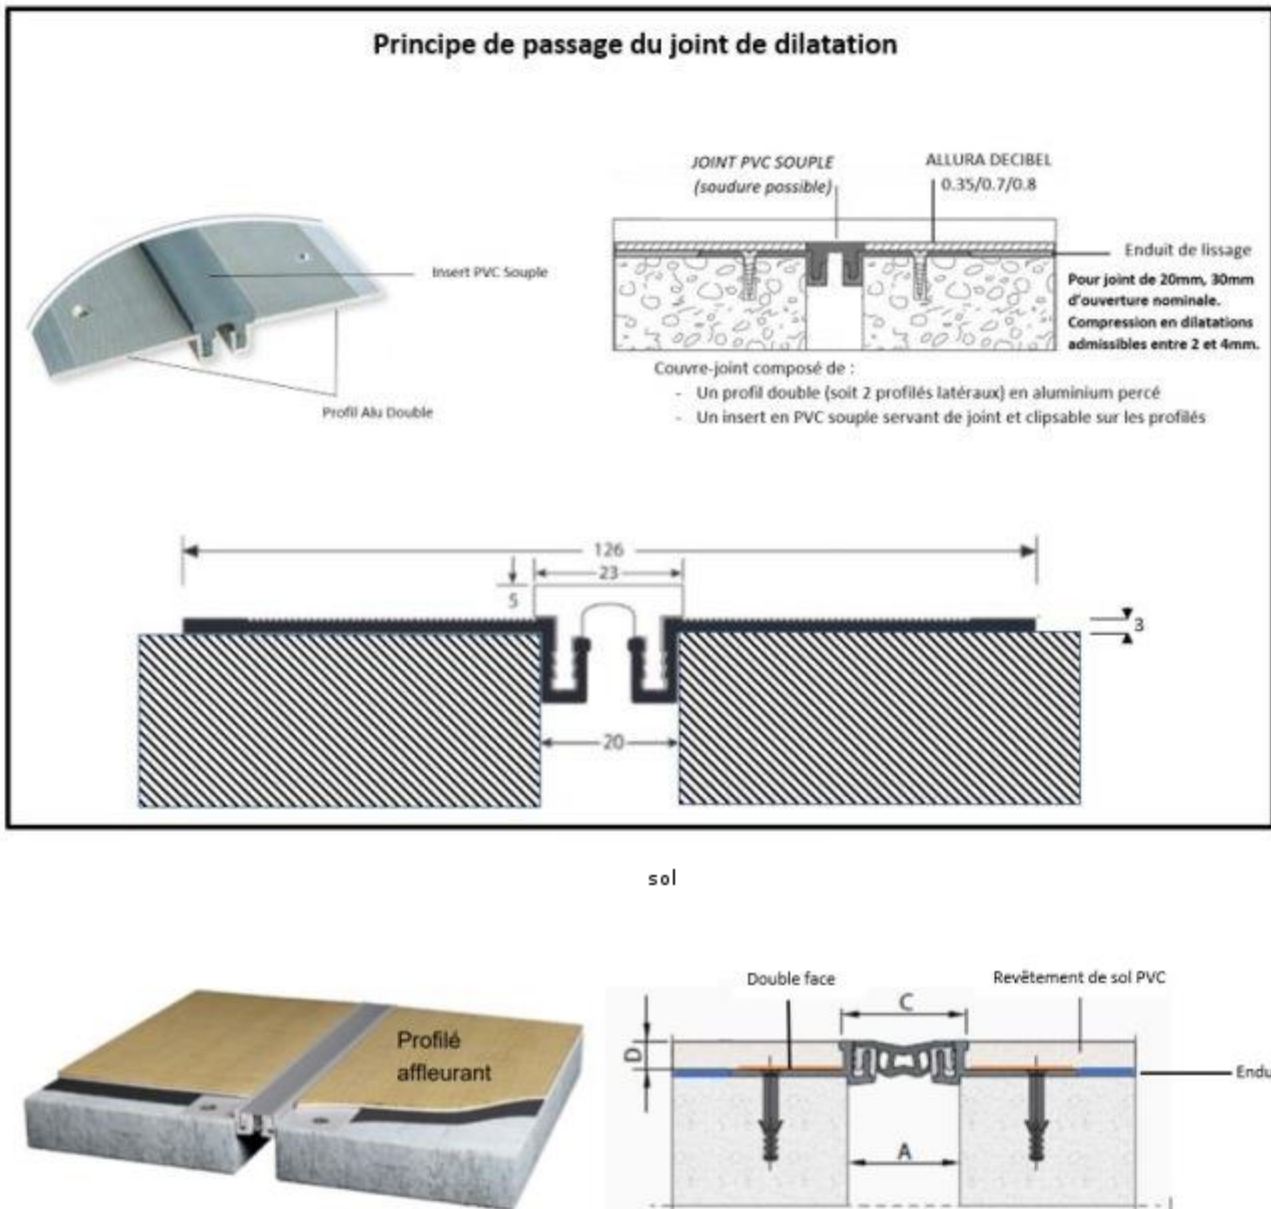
Exemples de profilés de recouvrement de joints de dilatation
